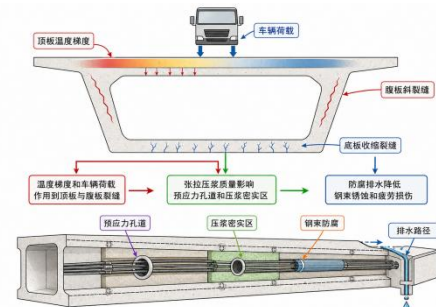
桥梁预应力混凝土箱梁裂缝成因与防治关系示意
